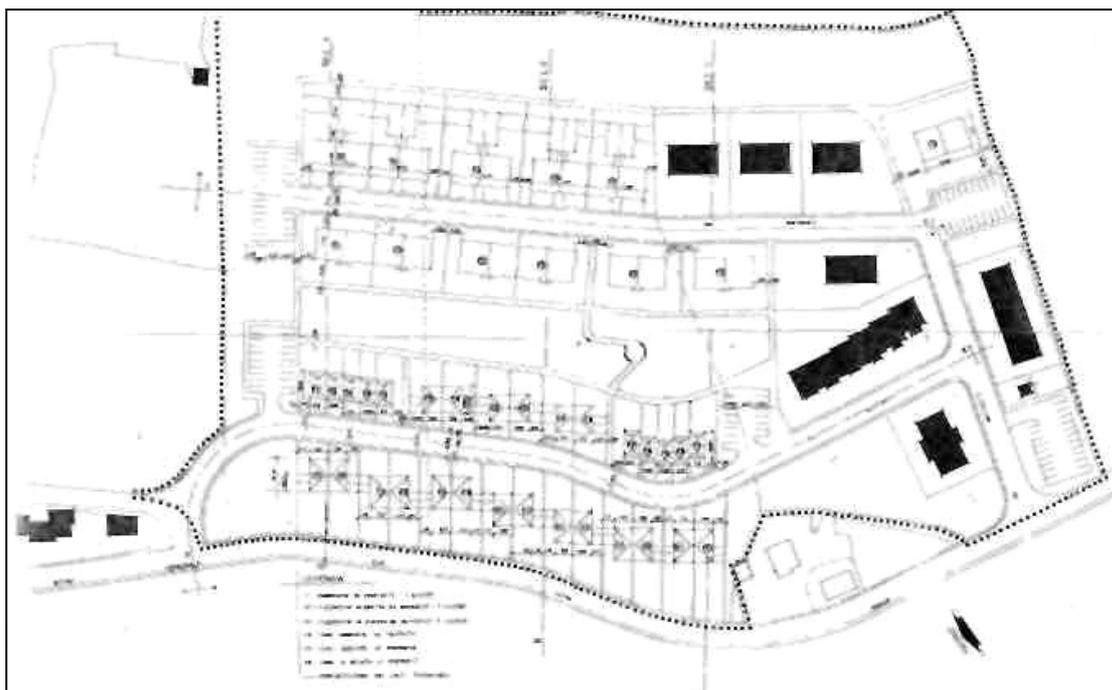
planimetria del PEEP di Rocca San Casciano.
